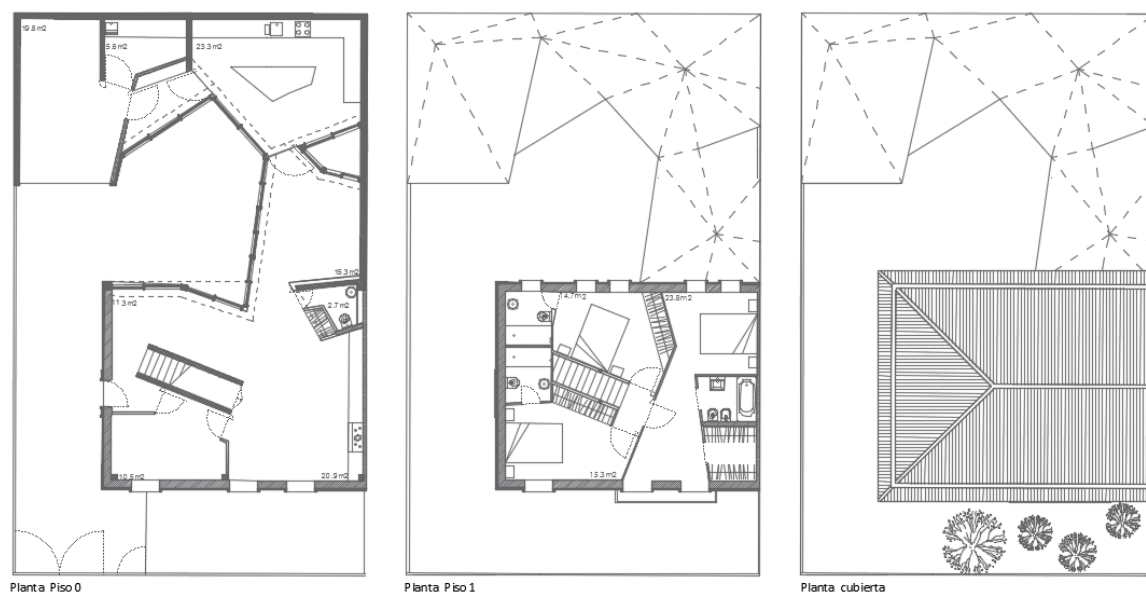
Planos en planta, proyecto localizado en la Rua do Marco de Canaveses, no 75. Porto
